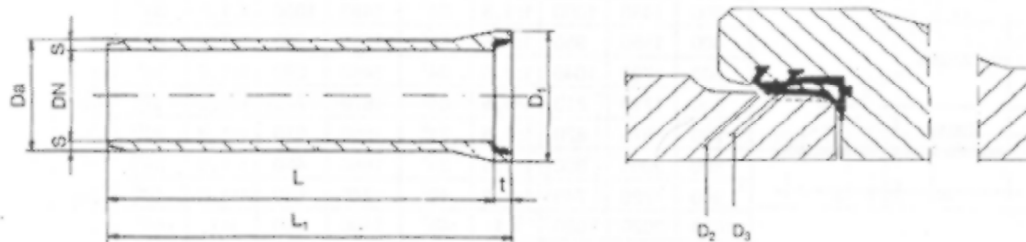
Betonrohr mit Verbindungselement [Casp 94].
